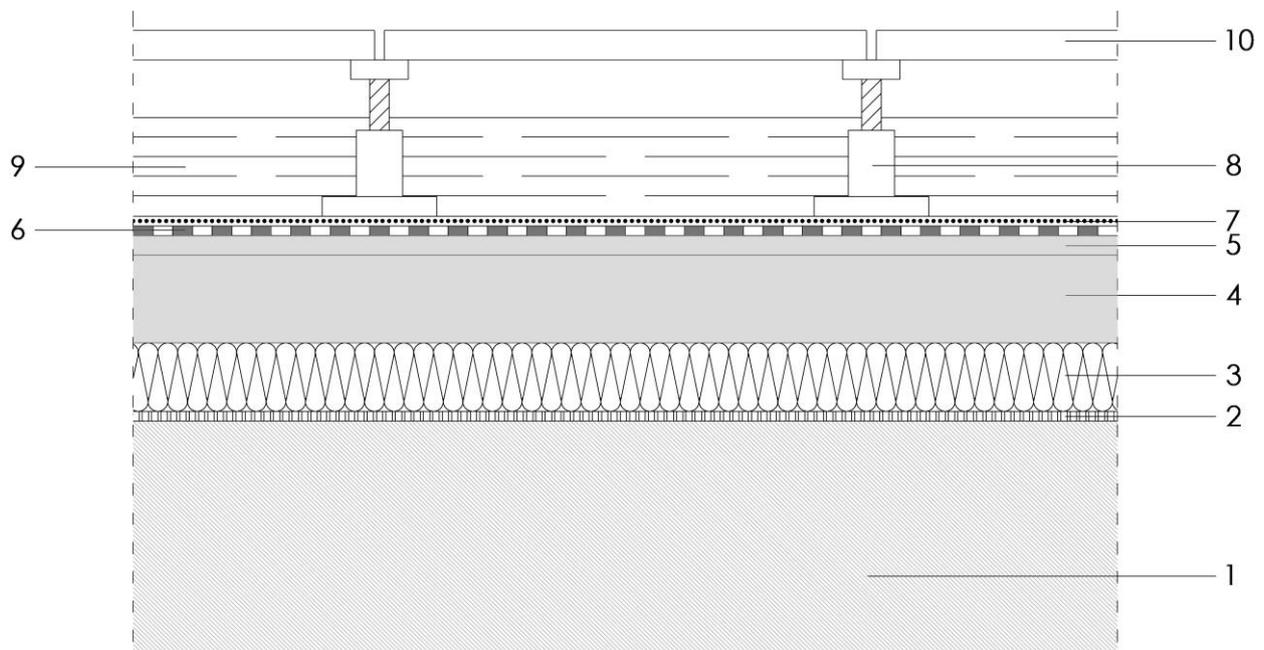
Detalle constructivo de cubierta inundada convencional transitable.
